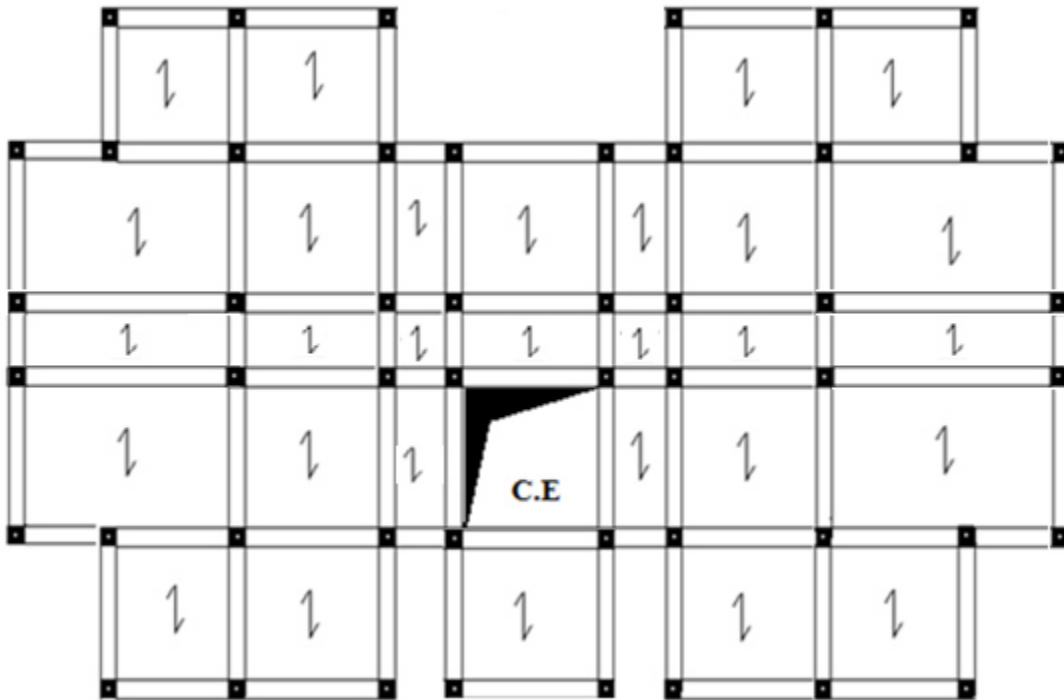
Schéma de la disposition des poutrelles (RDC).
